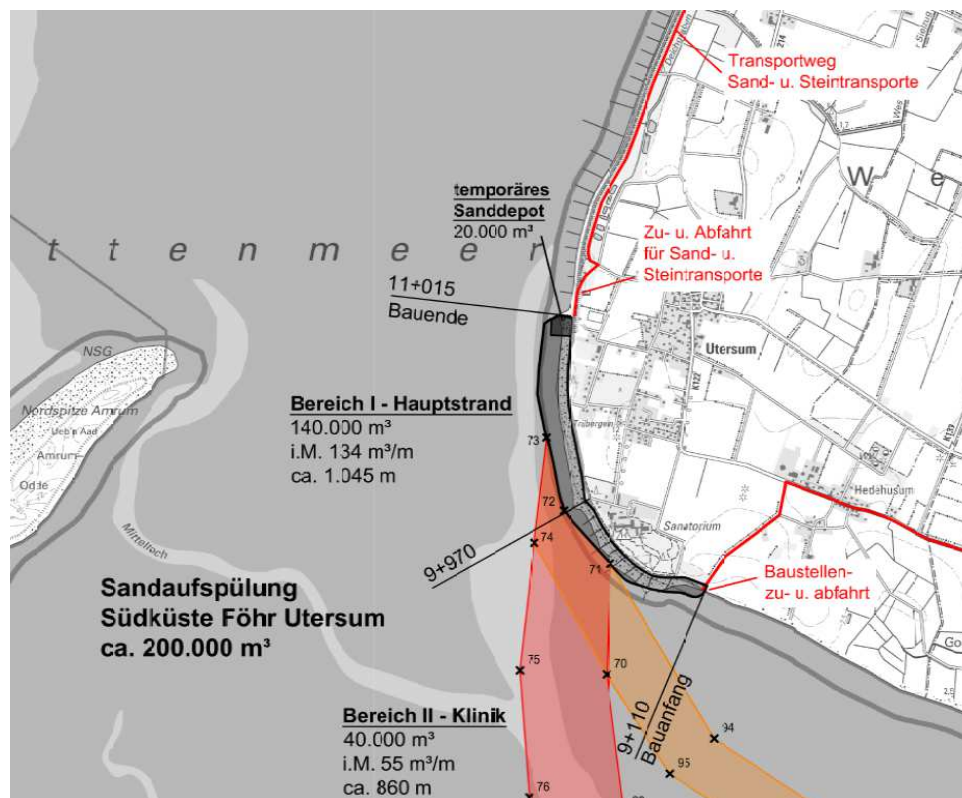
Lageplan Sandaufspülung Utersum / Föhr
